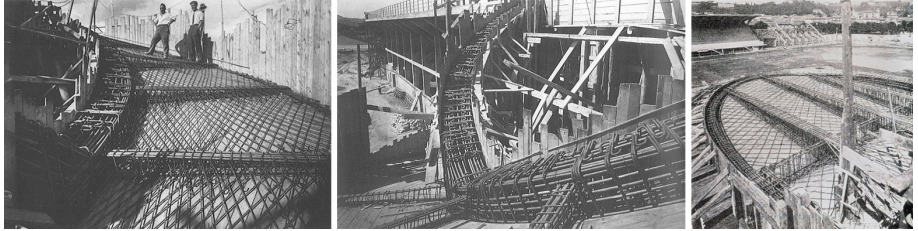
Da alcune fotografie di cantiere (1932): disposizione delle barre di armatura delle scale elicoidali e della pensilina ellittica¹⁷.
